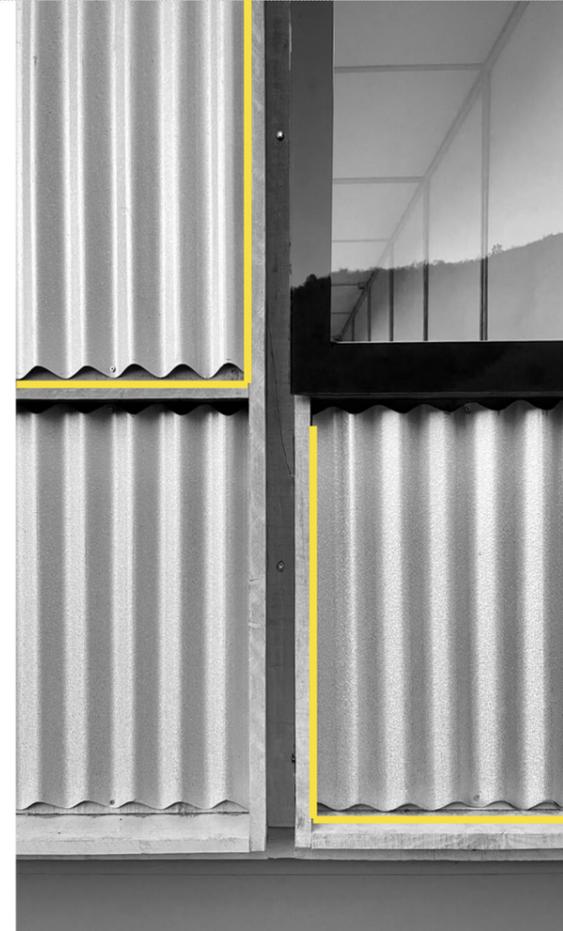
Revestimiento de aluminio en la obra Fuente: (Revista arquitectura viva, s. f.)
